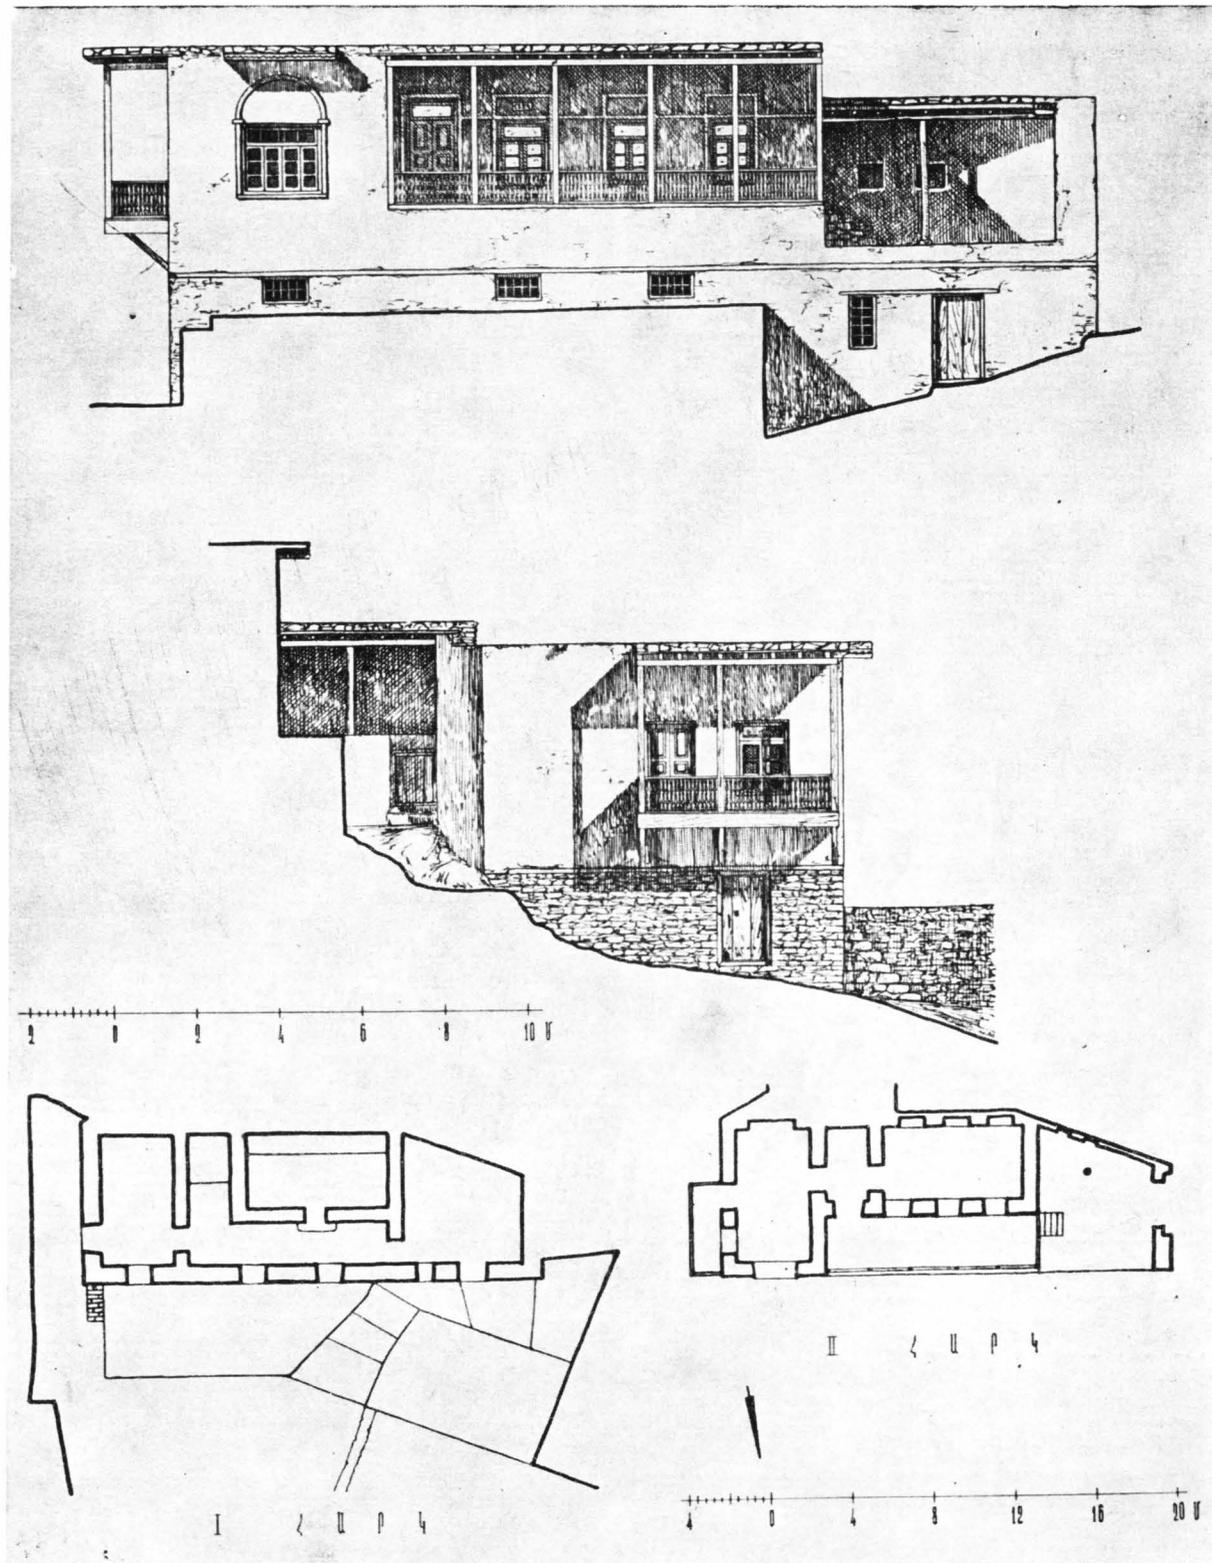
Maison de type urbain de Meghri (façades principale et latérale). Plans du rez-de-chaussée et du 1^{er} étage).
